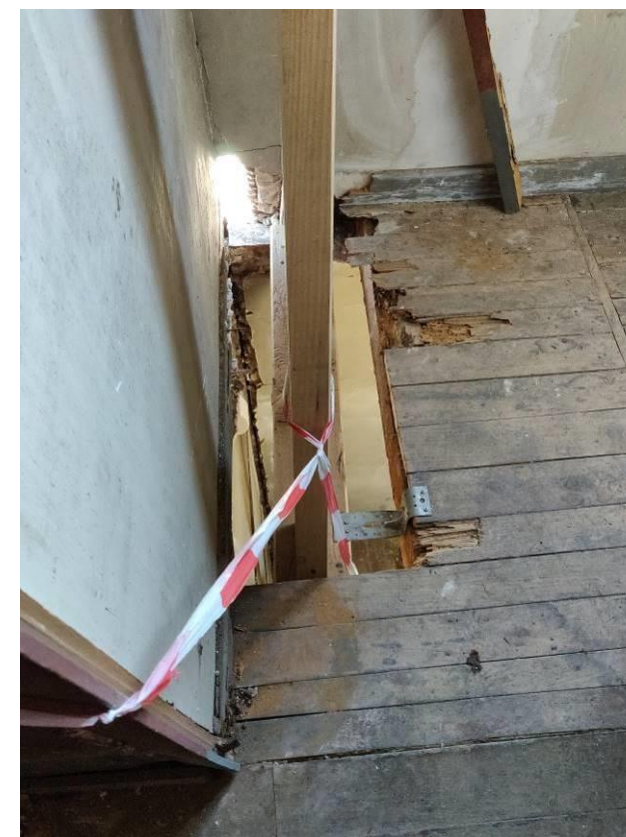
Niveau 3^{ème} balcon – Coursive côté rue d'Ulm très dégradée et étayée – Détail angle Ouest
